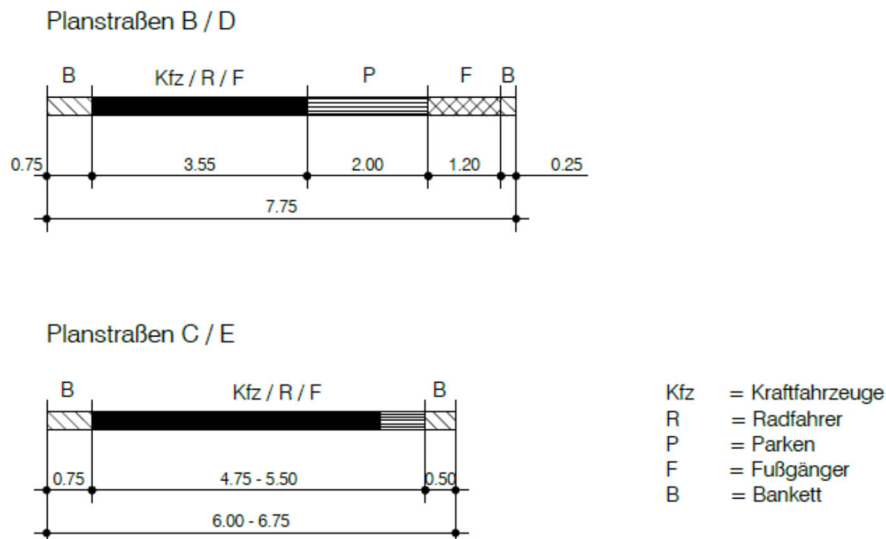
empfohlener Querschnitt Planstraßen B,C,D und E
